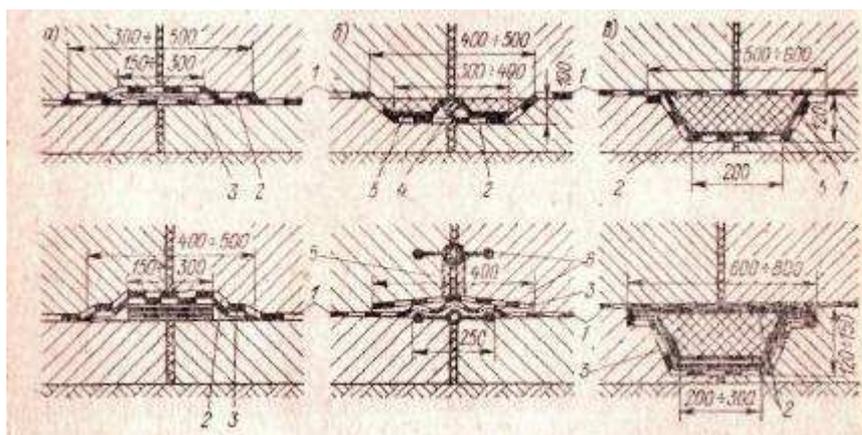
Устройство пересечений гидроизоляционных покрытий с деформационными швами в основании сооружений (к п. 2.27)
